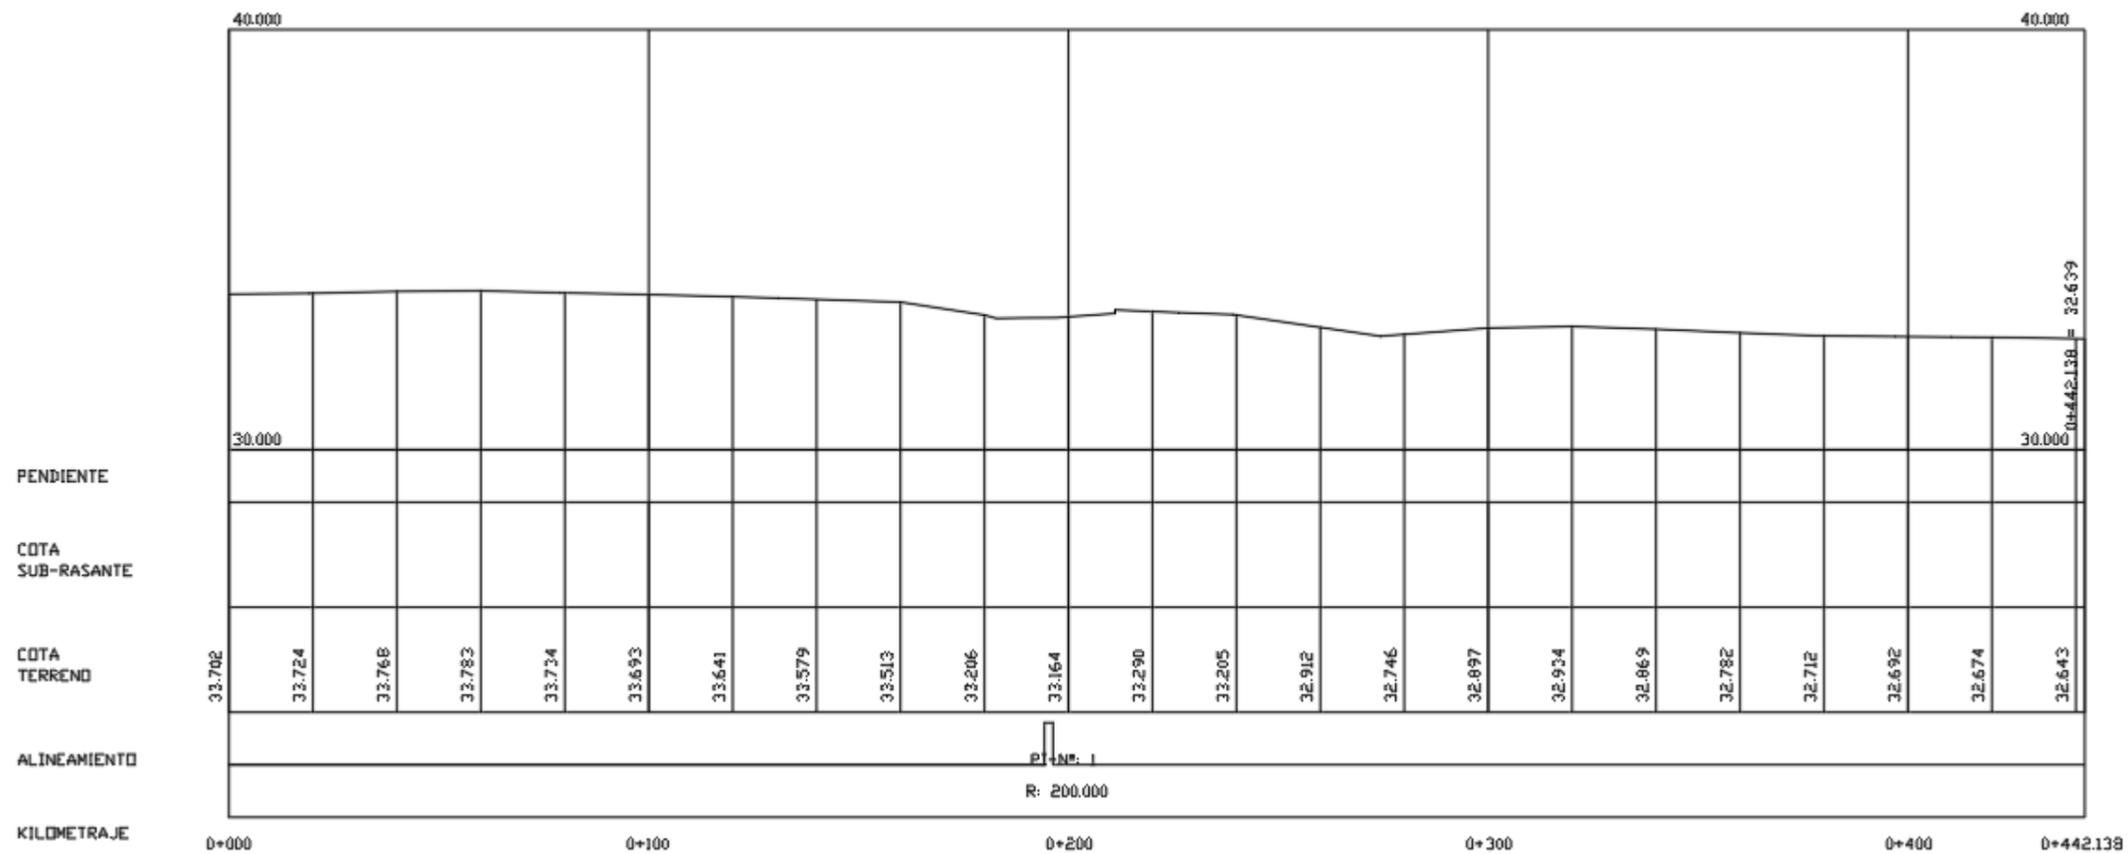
Perfil Longitudinal de la Vía Evitamiento.
